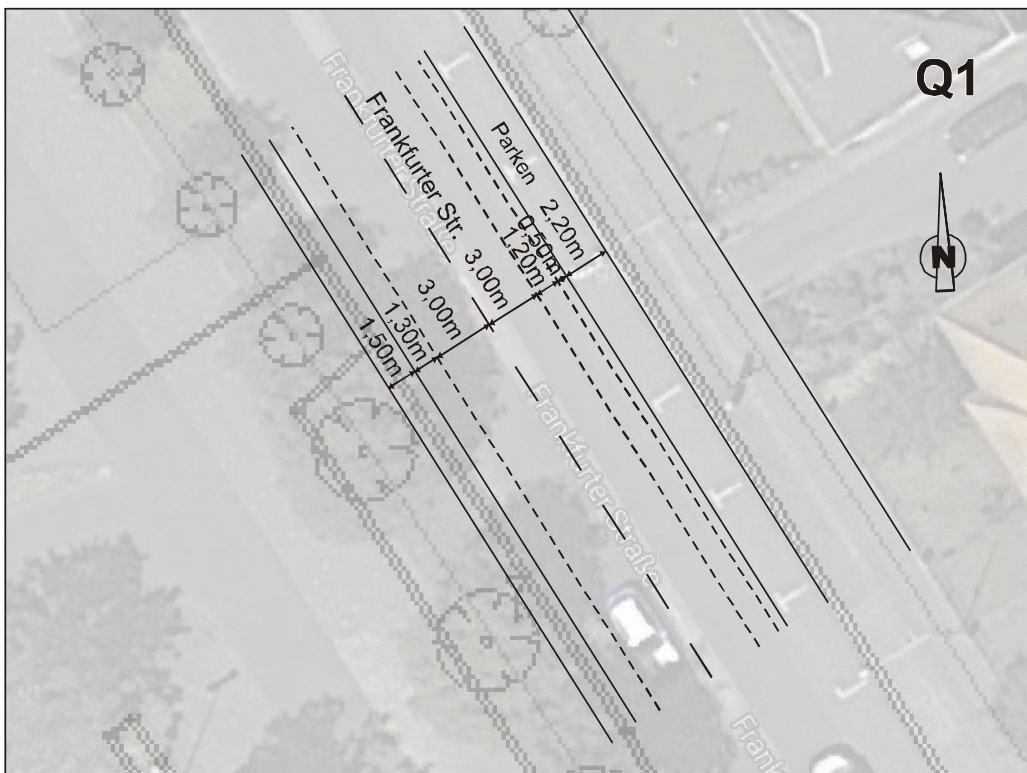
Querschnitt Frankfurter Straße, Abschnitt Steinfurter Straße/Benekestraße
